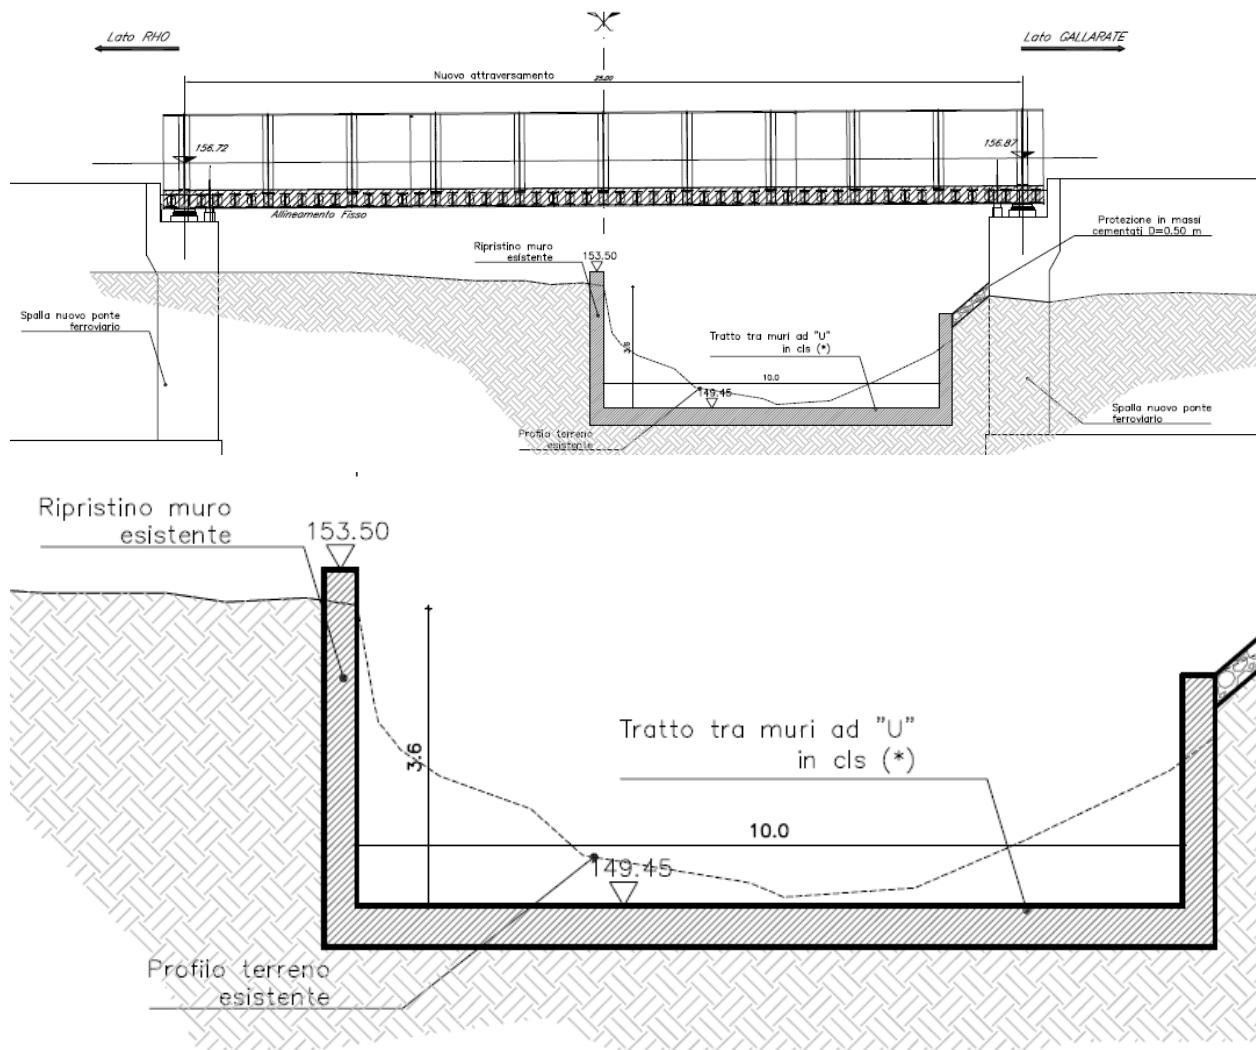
Sezione del nuovo attraversamento ferroviario e dettaglio della riprofilatura dell'alveo, in sua corrispondenza.
